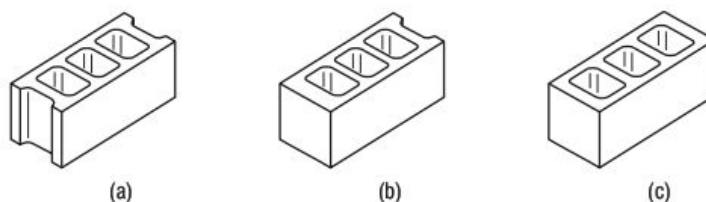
Elementos de mampostería de hormigón: (a) sin terminación, (b) de terminación simple y (c) de doble terminación.
